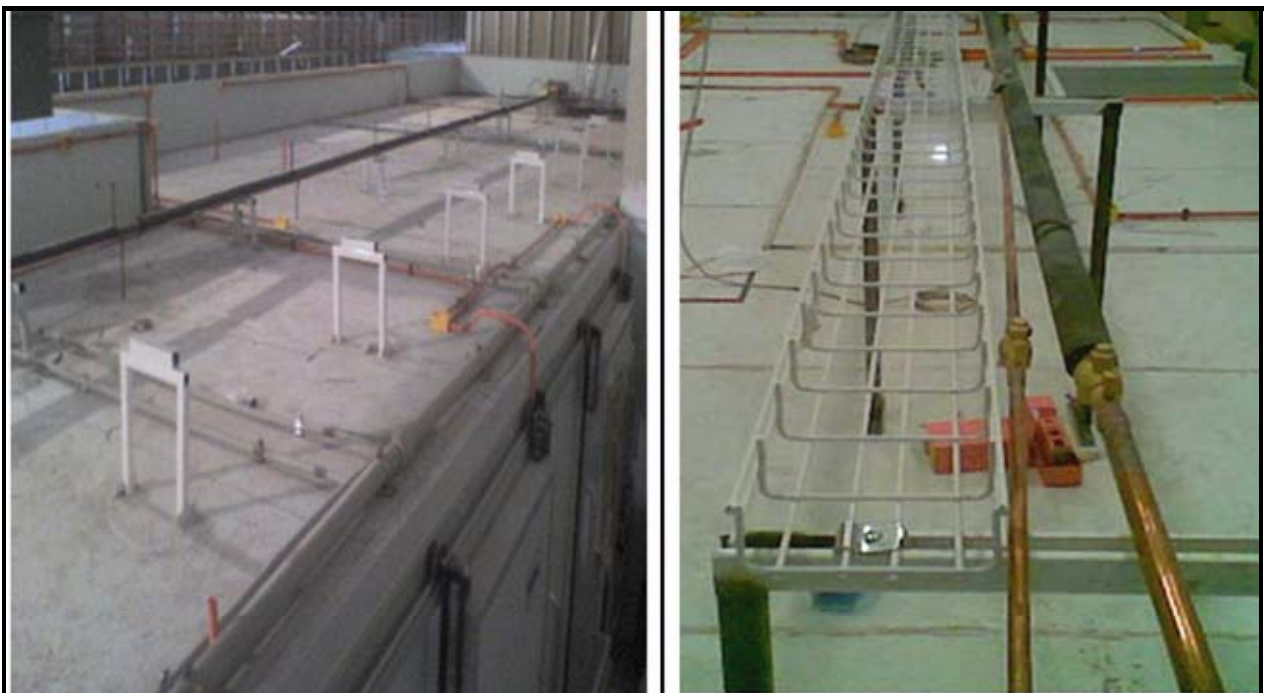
Distancia entre soportación y montaje de escalerilla.
